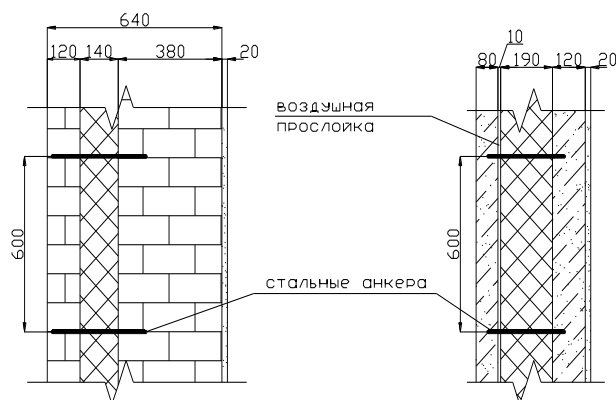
Конструкция наружной кирпичной и панельной стены
